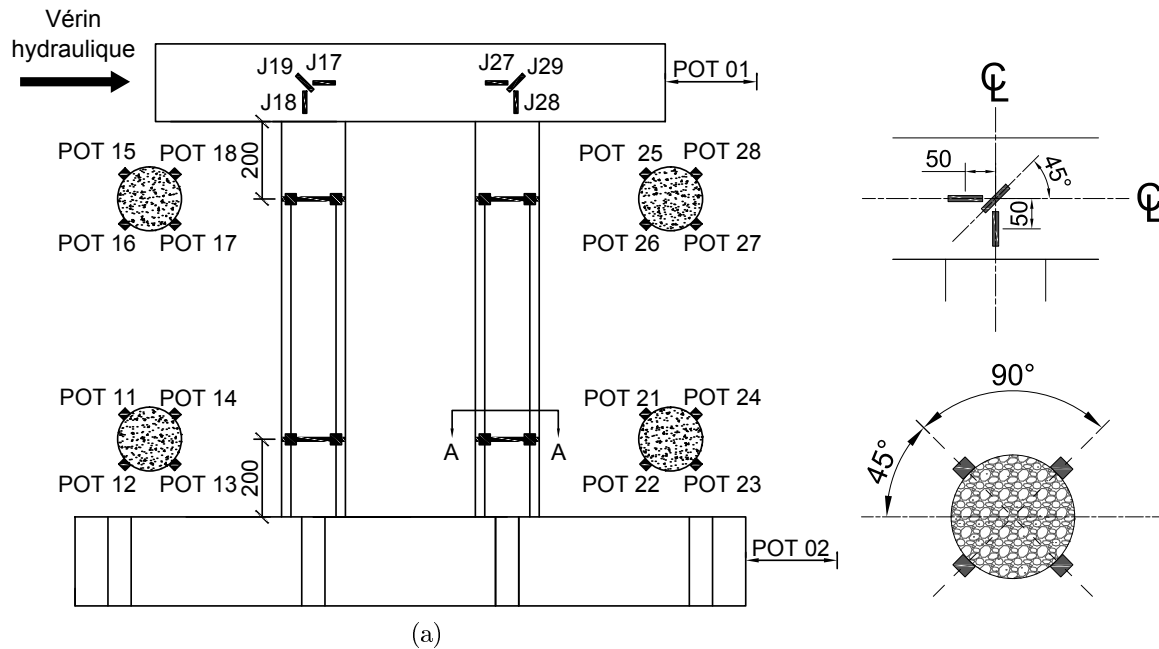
Instrumentation externe de la pile 02 : (a) vue en élévation, (b) détail des jauges, (c) coupe A-A : potentiomètres des anneaux
